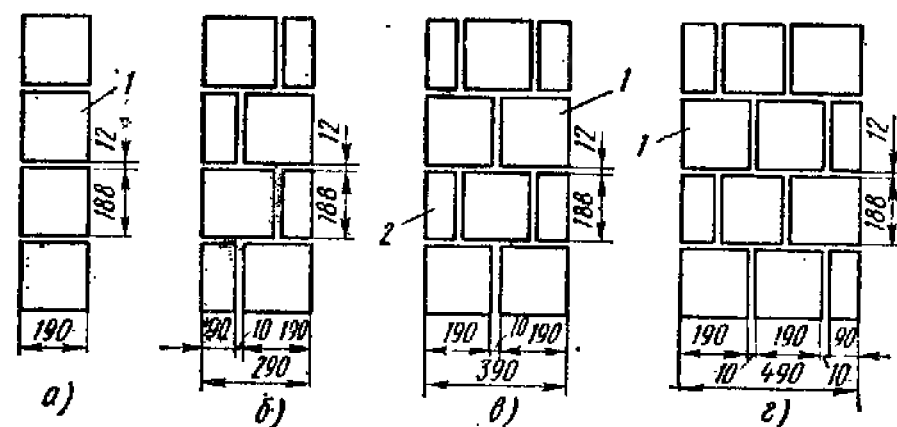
Перевязка кладки из легкобетонных камней с щелевыми пустотами:
